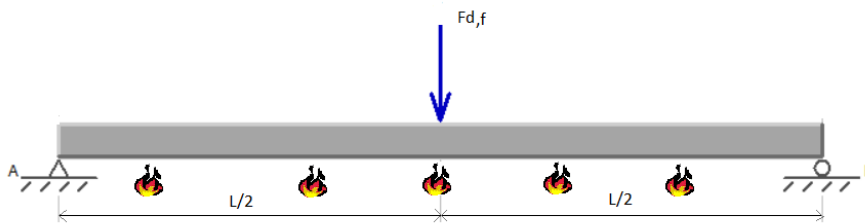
Viga simplesmente apoiada com carga sujeita ao fogo
